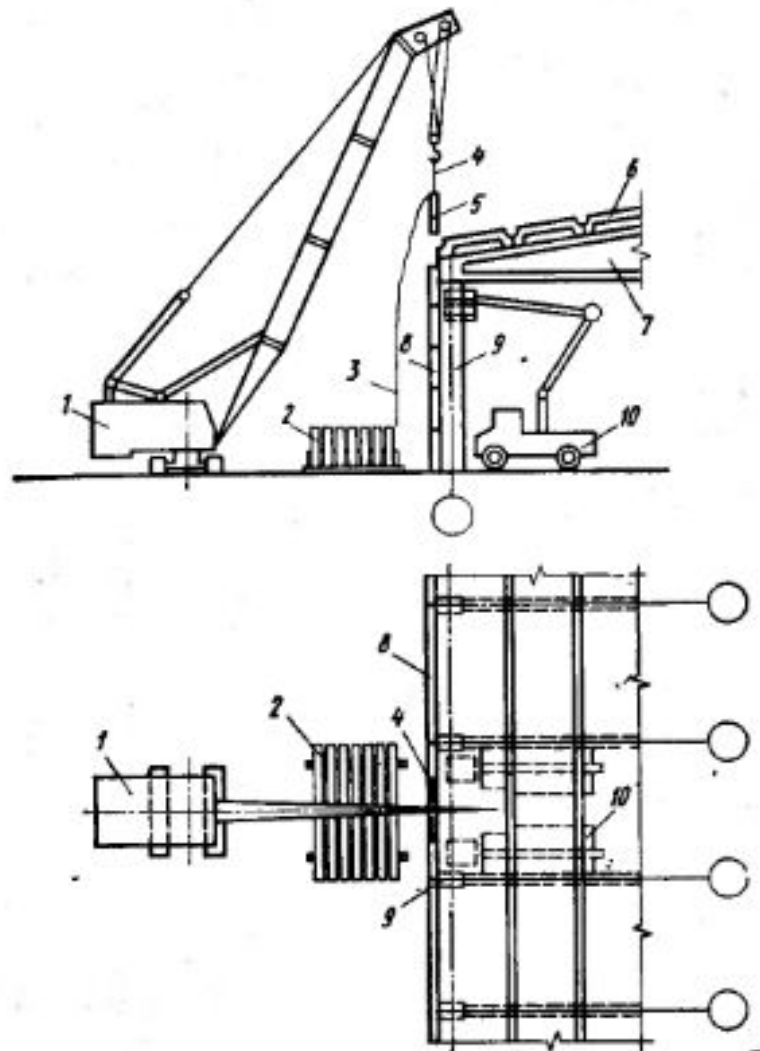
Схема монтажа стеновых ограждающих панелей, кран расположен между кассетой и стеной:
